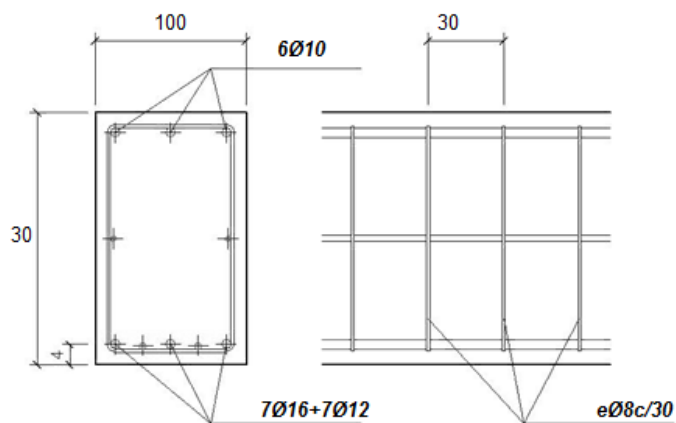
Esquema de la armadura del módulo tipo losa. Fuente: Elaboración propia.
